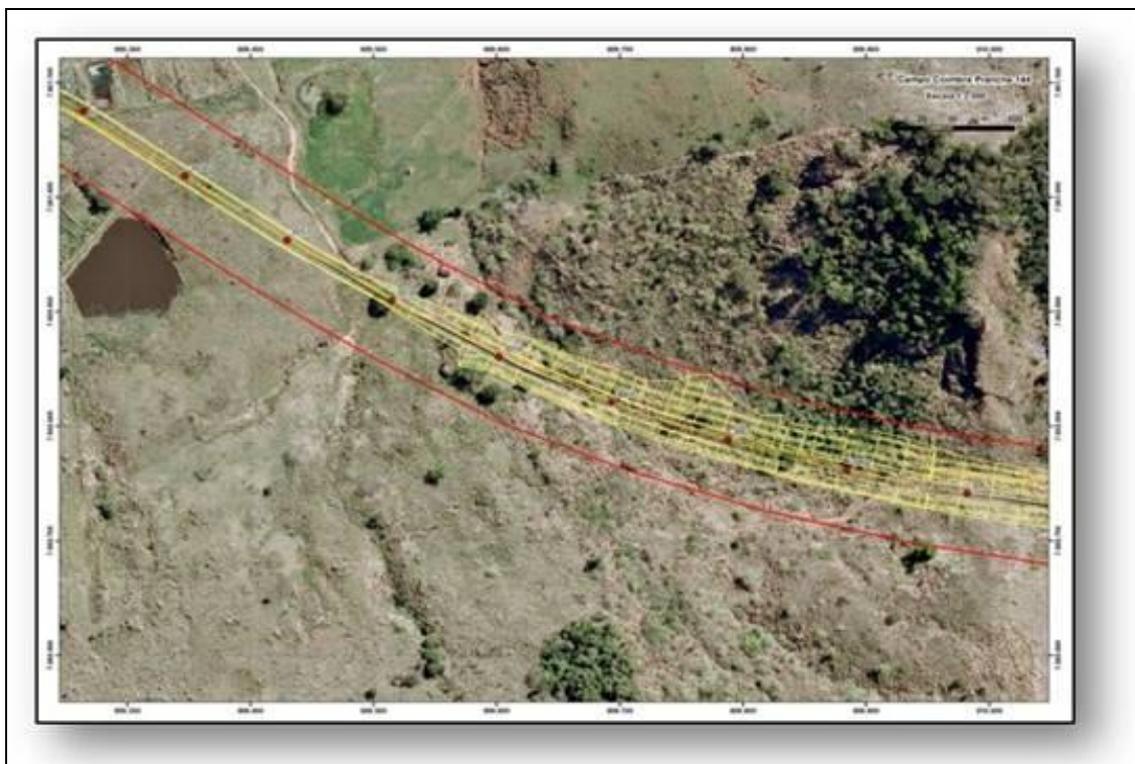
Desenho esquemático do talude de corte (amarelo) em planta
